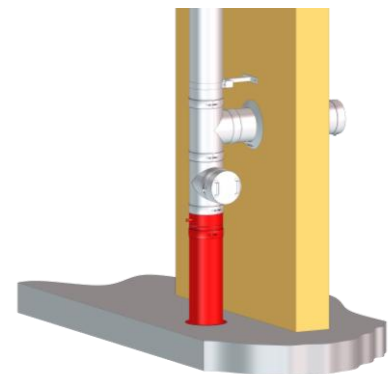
Aufbau mit Teleskopstütze und T-Anschluss z. B. 90°
